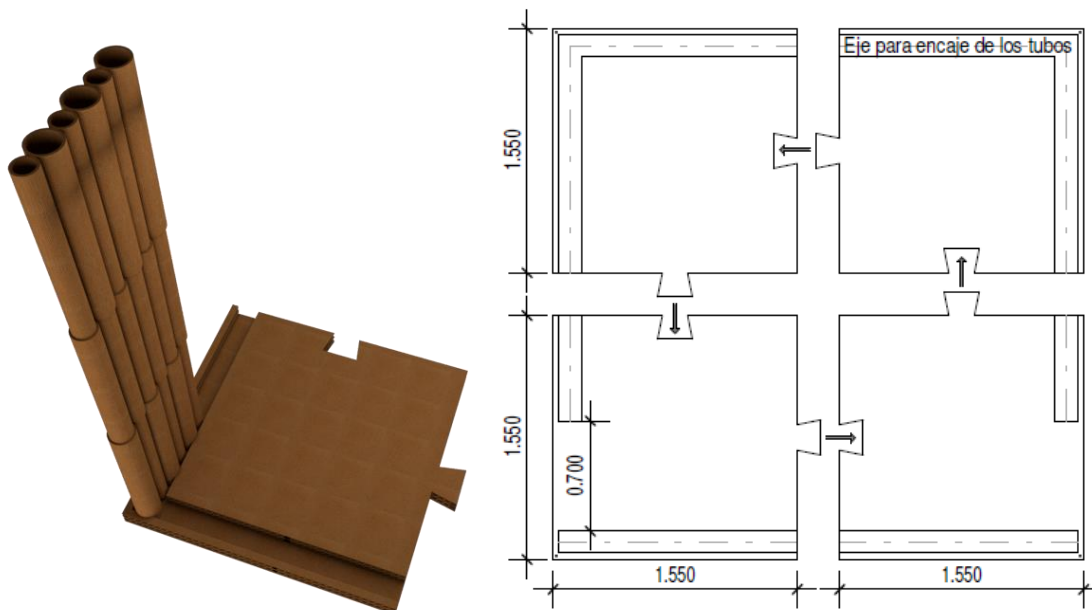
Detalles de Conjuntos y tubos de muros con puerta. Fuente: Desarrollado por el autor
